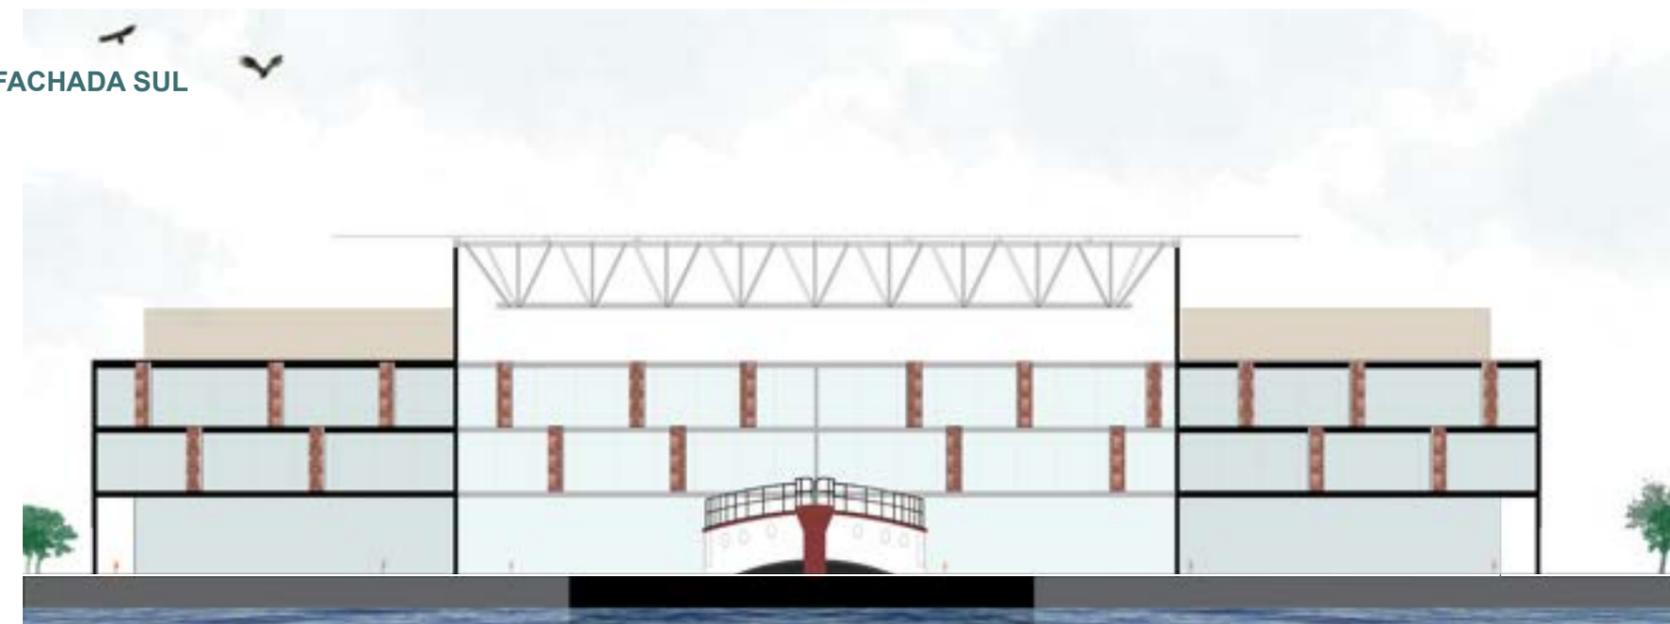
Fachada Sul. Fonte: Autoria própria
